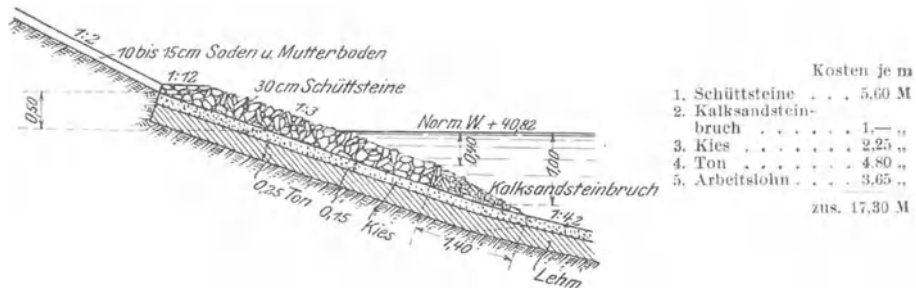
Flache Uferbefestigung am Oder-Spree-Kanal mit Dichtung.
